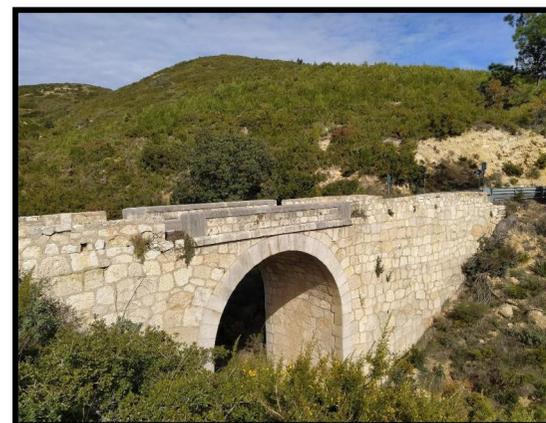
Estructura actual sobre barranco Fuente: Elaboración propia.
